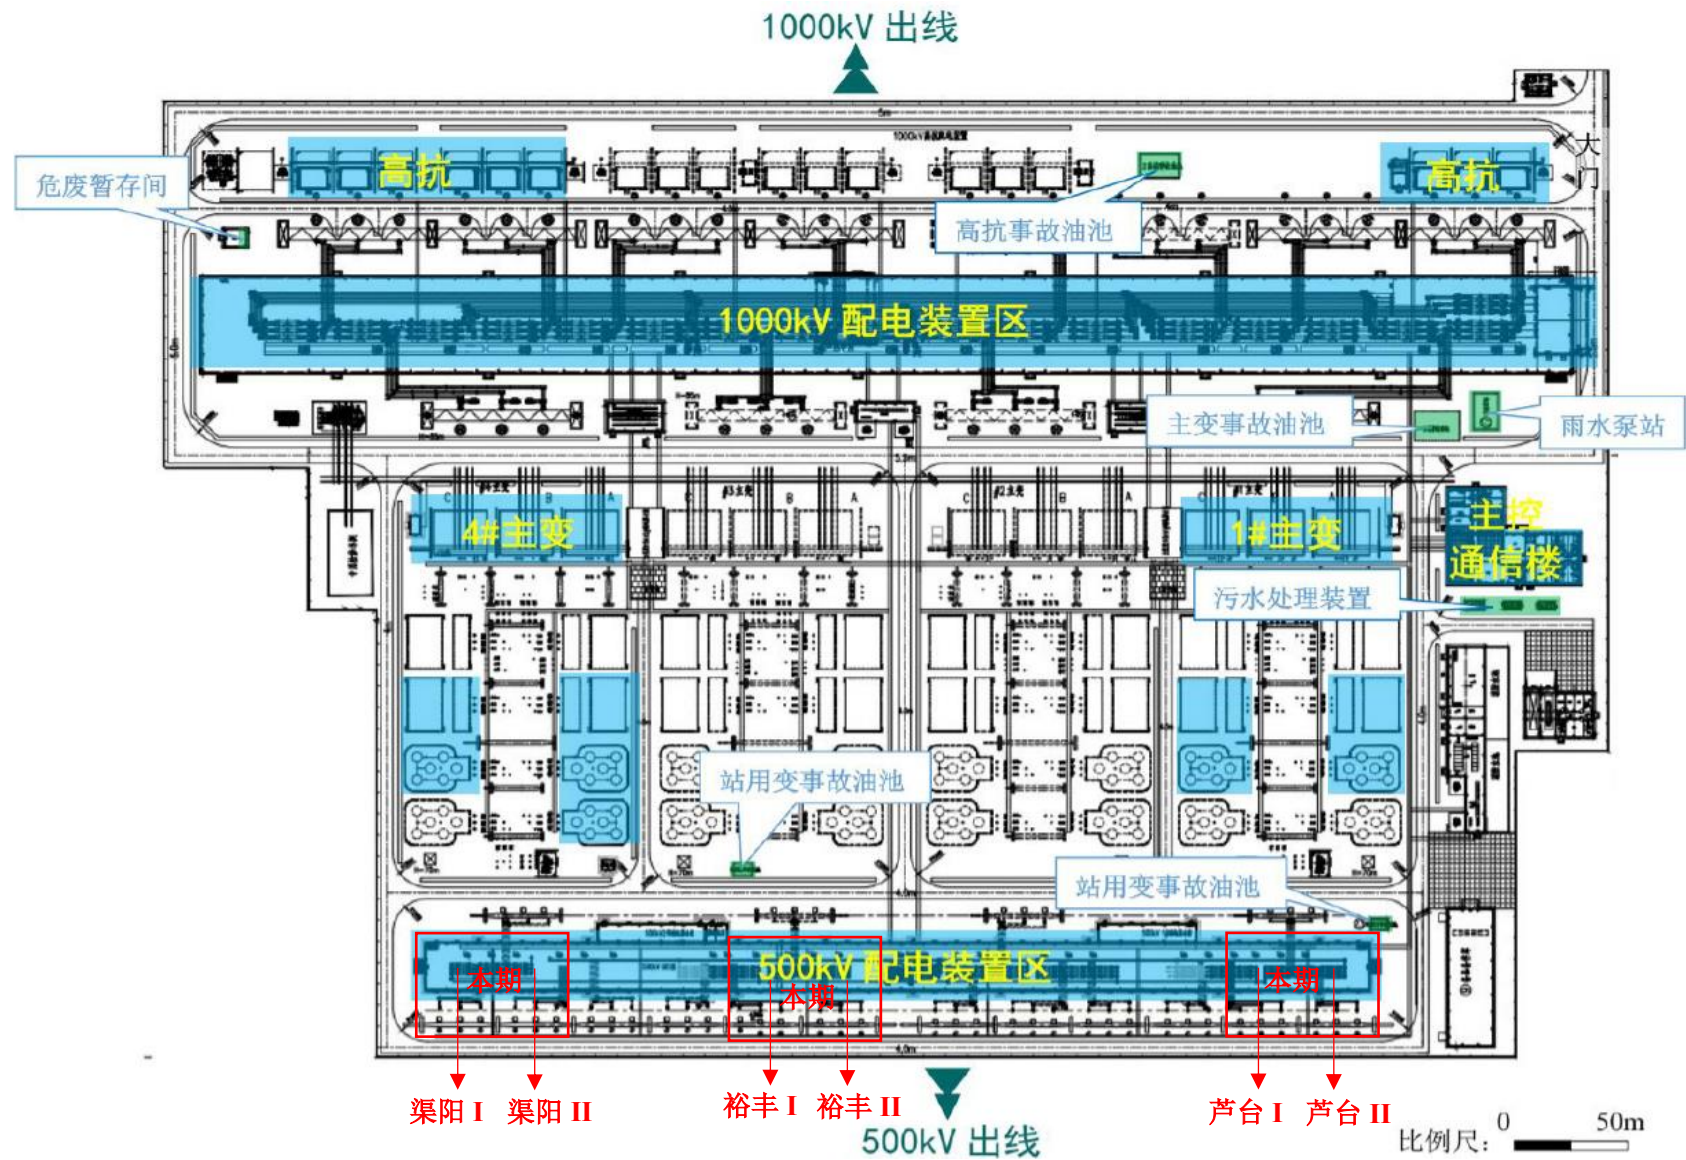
天津北 1000kV 变电站平面布置示意图
